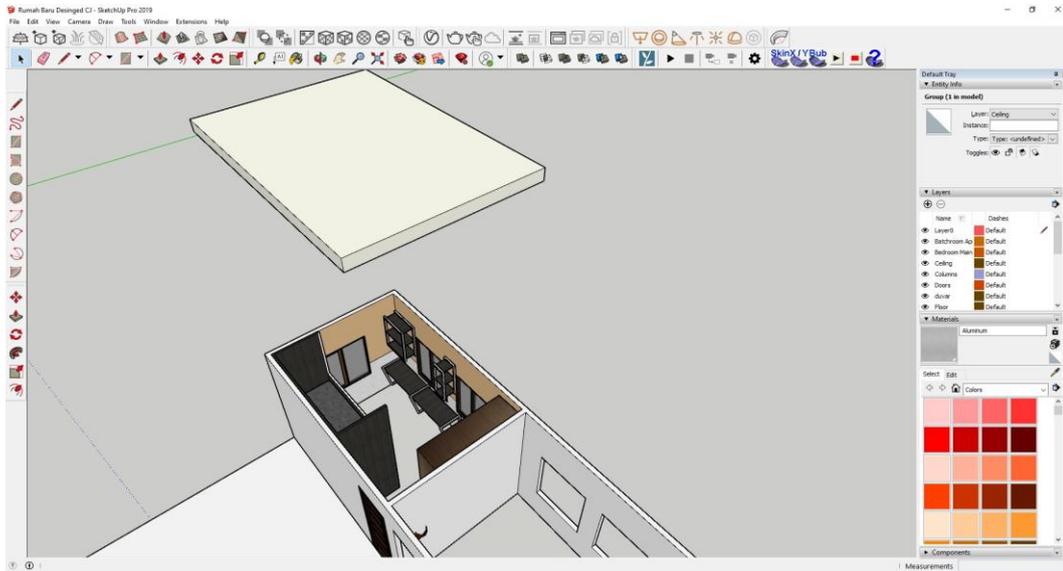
4 Denah Lantai Dua Yang Dirancang, Sumber : Arsip Pribadi
